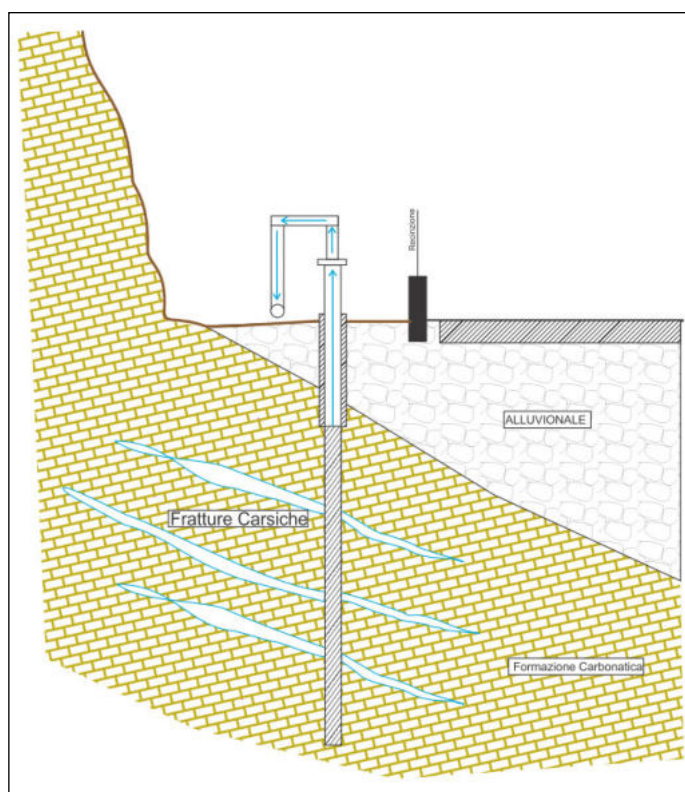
Schema Pozzo Ratto (Sezione Geologica)
